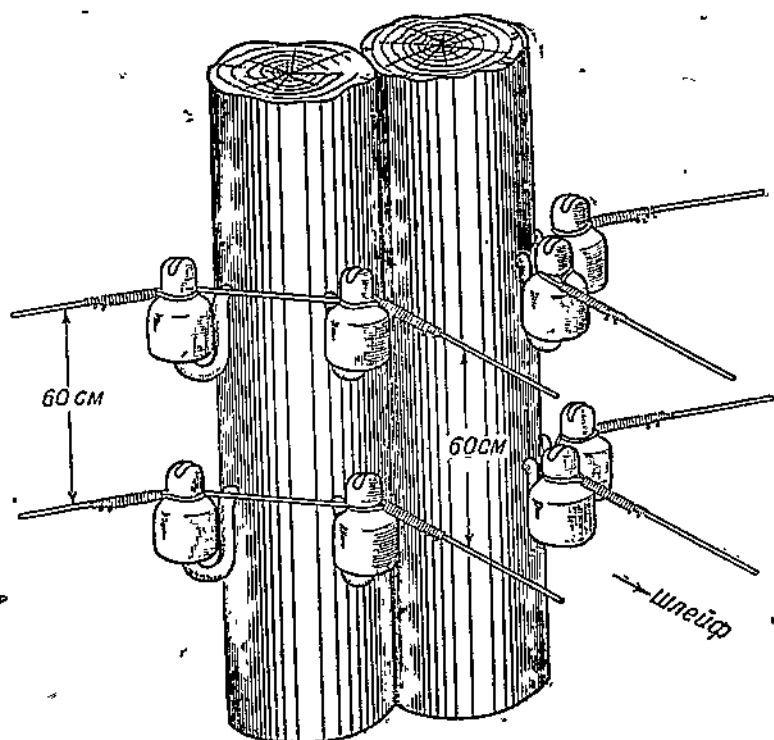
Монтаж проводов на разрезной опоре при расположении проводов на крюках.
